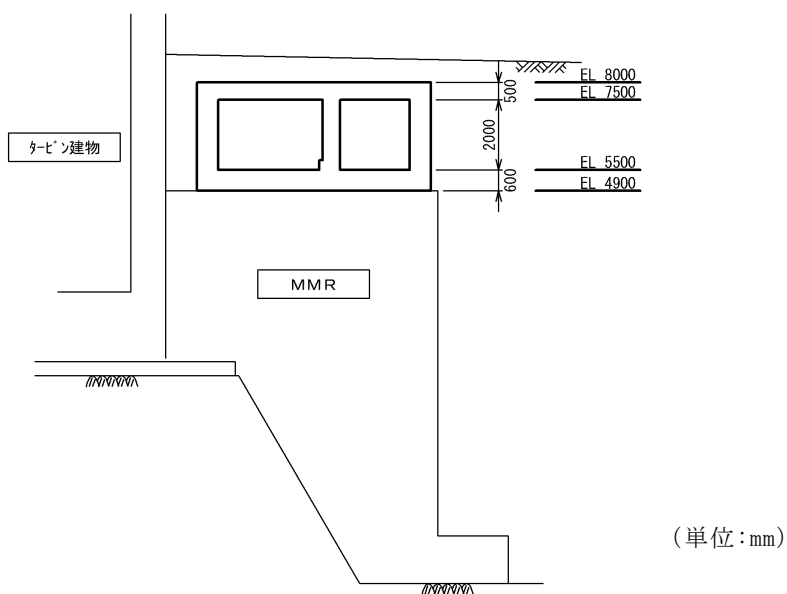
屋外配管ダクト (タービン建物～排気筒) 断面図 (A-A 断面)
